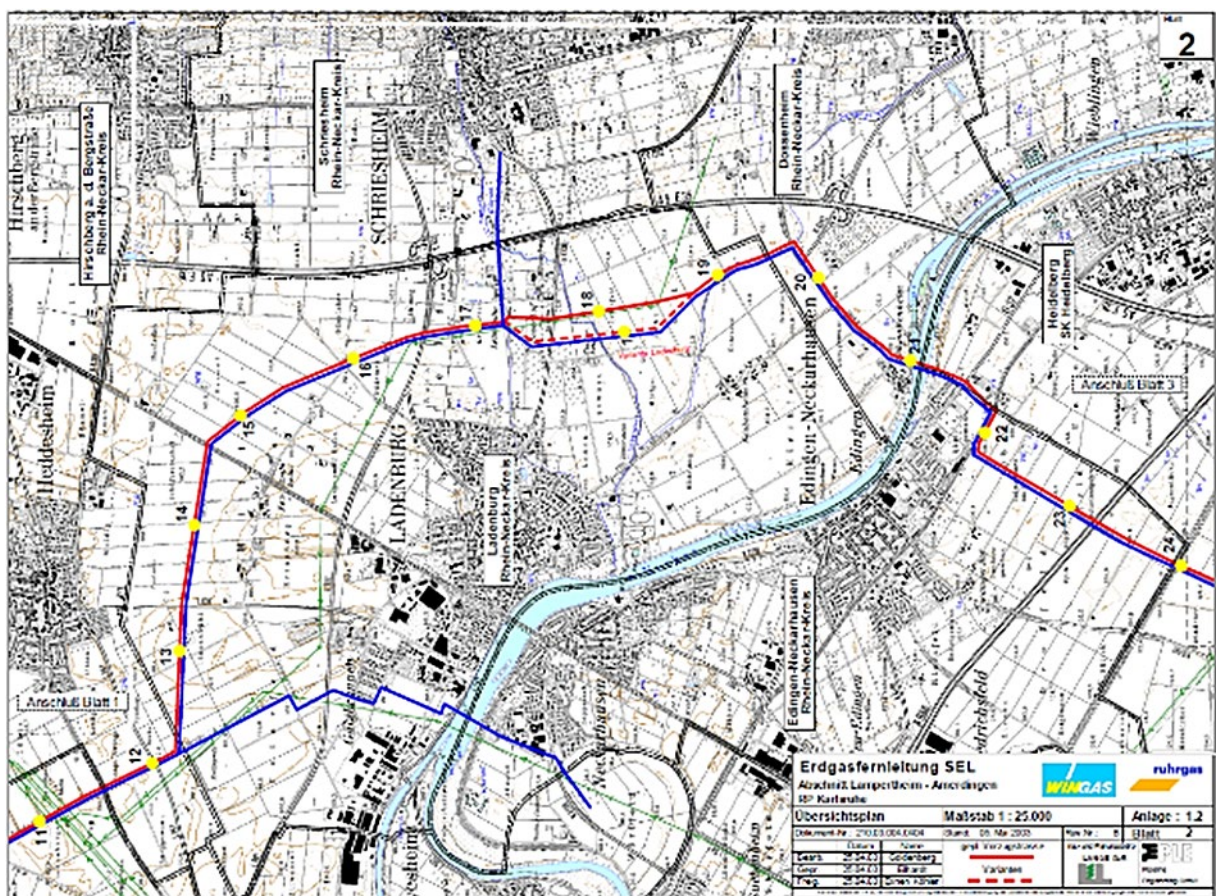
Lageplan Variante Ladenburg (Quelle: ROV)
